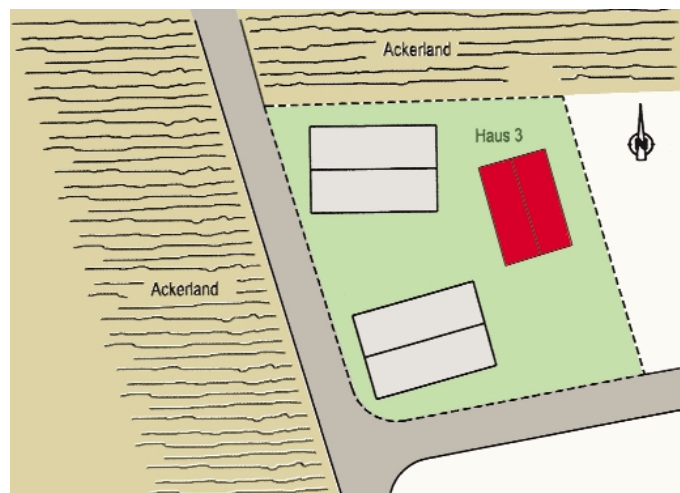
Lageplan des zweistöckigen Versuchshauses (Haus 3) am Stadtrand von Rosenheim
